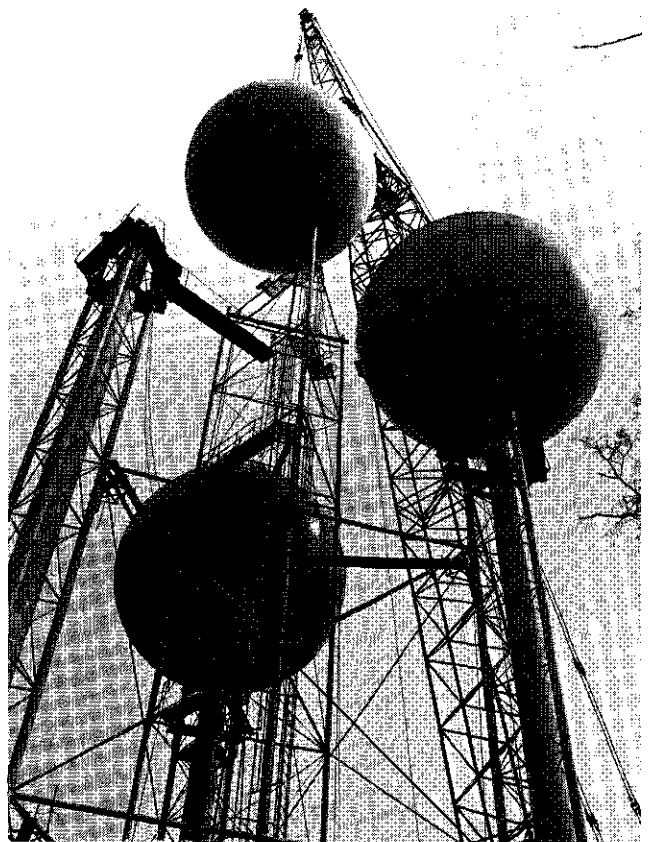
Het hijsen van de bol op de ondersteuningsconstructie.
